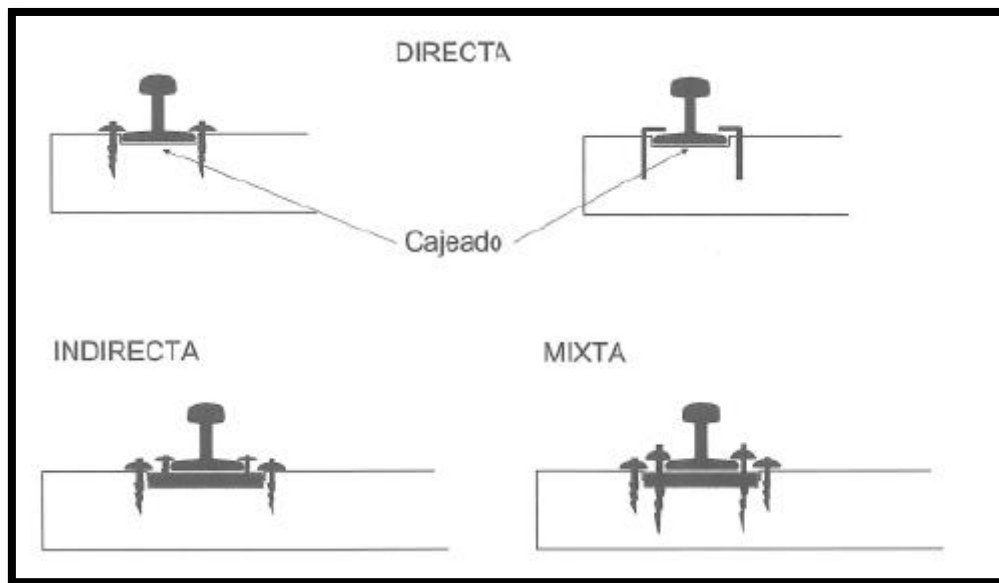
Tipos de sujeciones según las traviesas. [2]
